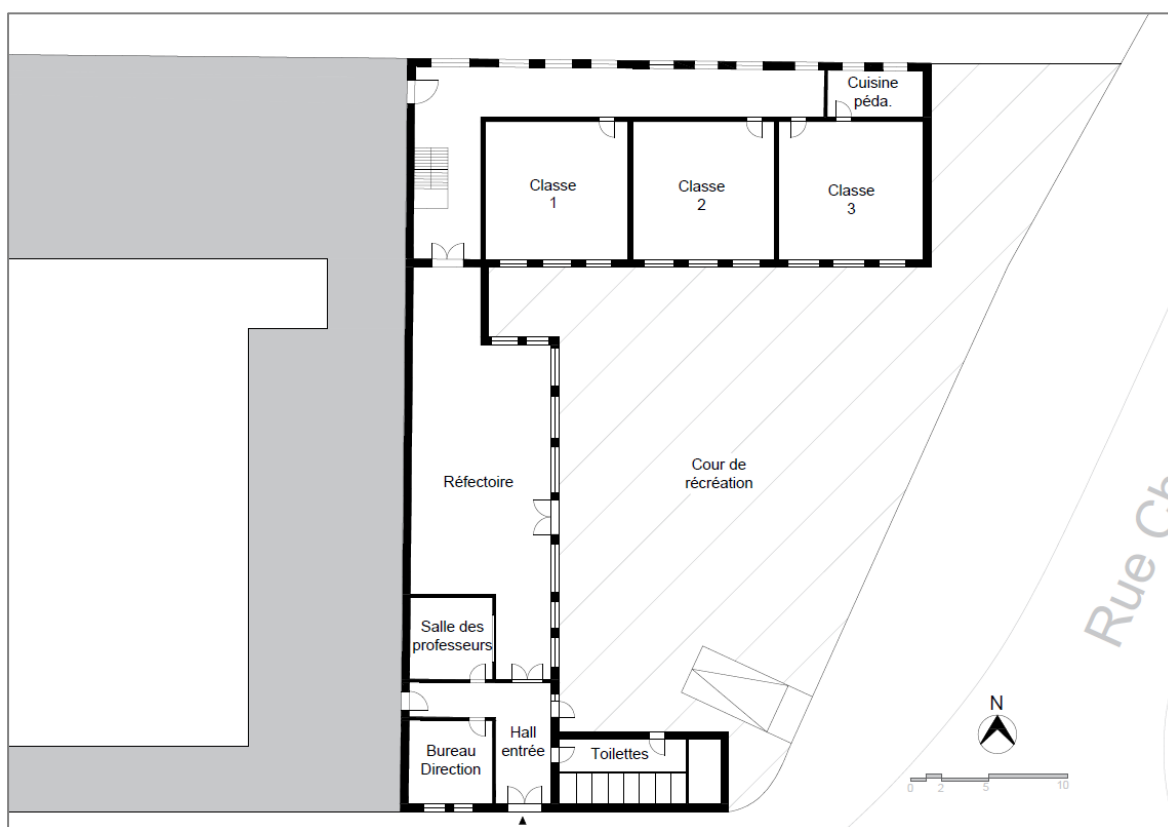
Plan du rez-de-chaussée - La Colline de l'Éveil (Daumalle, 2026)
